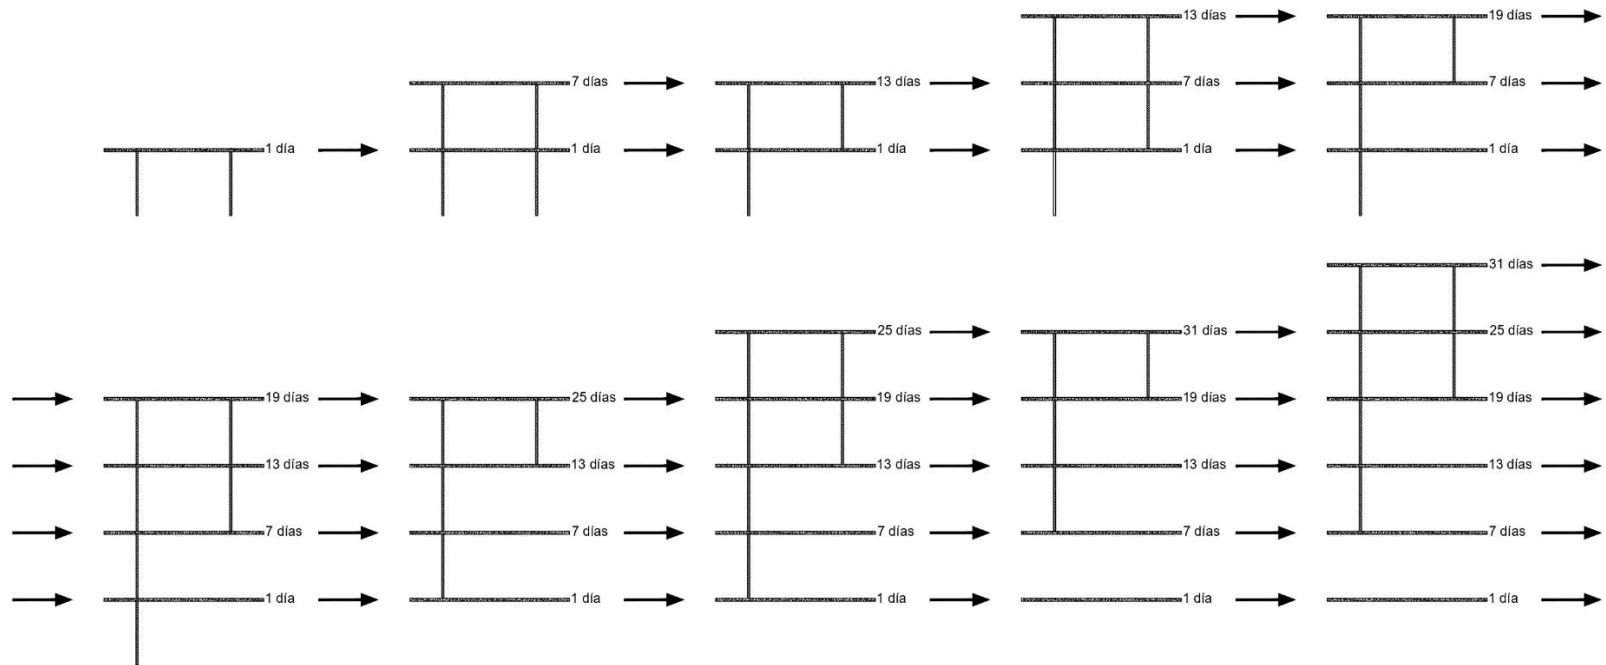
Secuencia de apuntalamiento y desapuntalamiento para una losa de una planta de entrepiso colada en seis secciones
